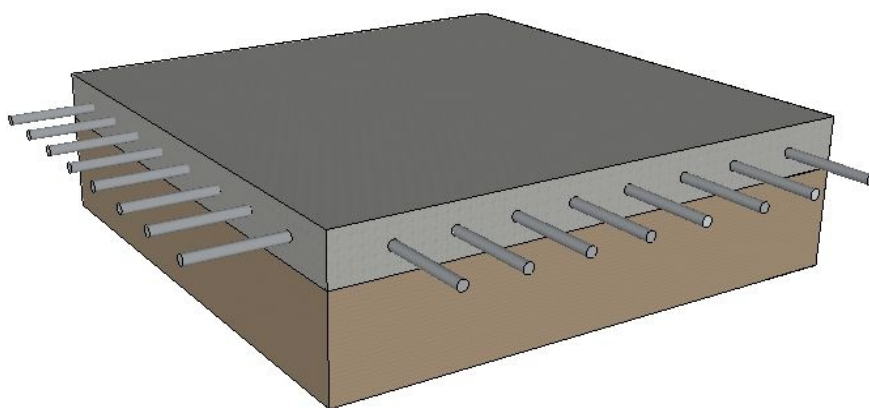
Pacchetto della pavimentazione allo stato attuale
